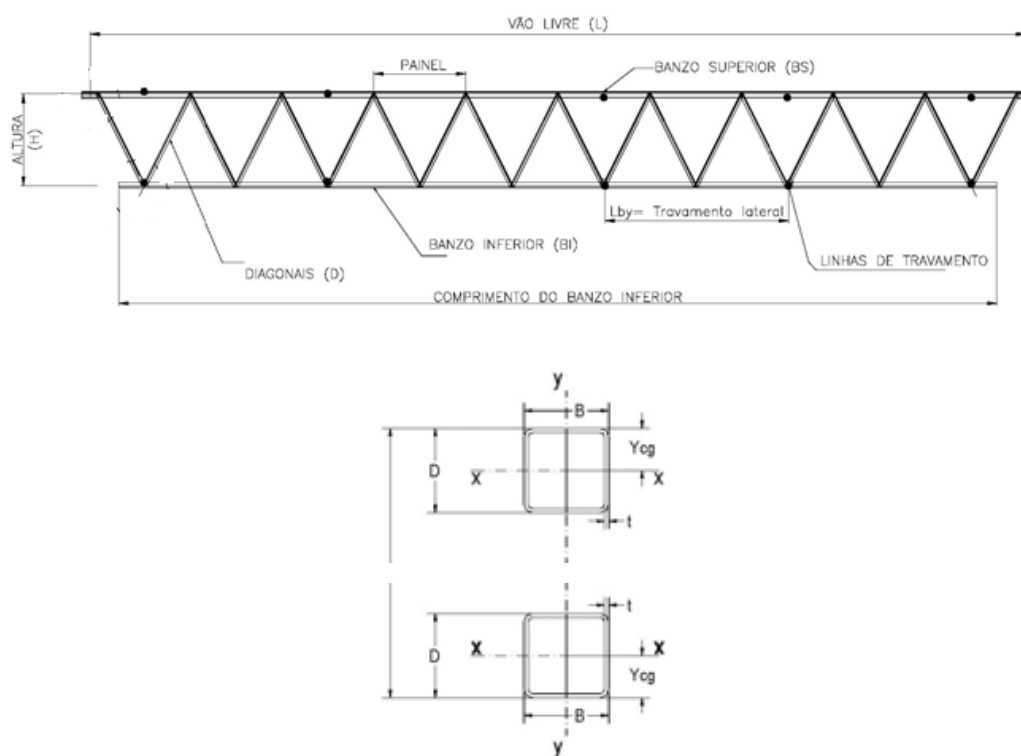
Treliça Tipo Steel Joist Tubular Quadrado (Adaptado de D'Alambert, 2007)
